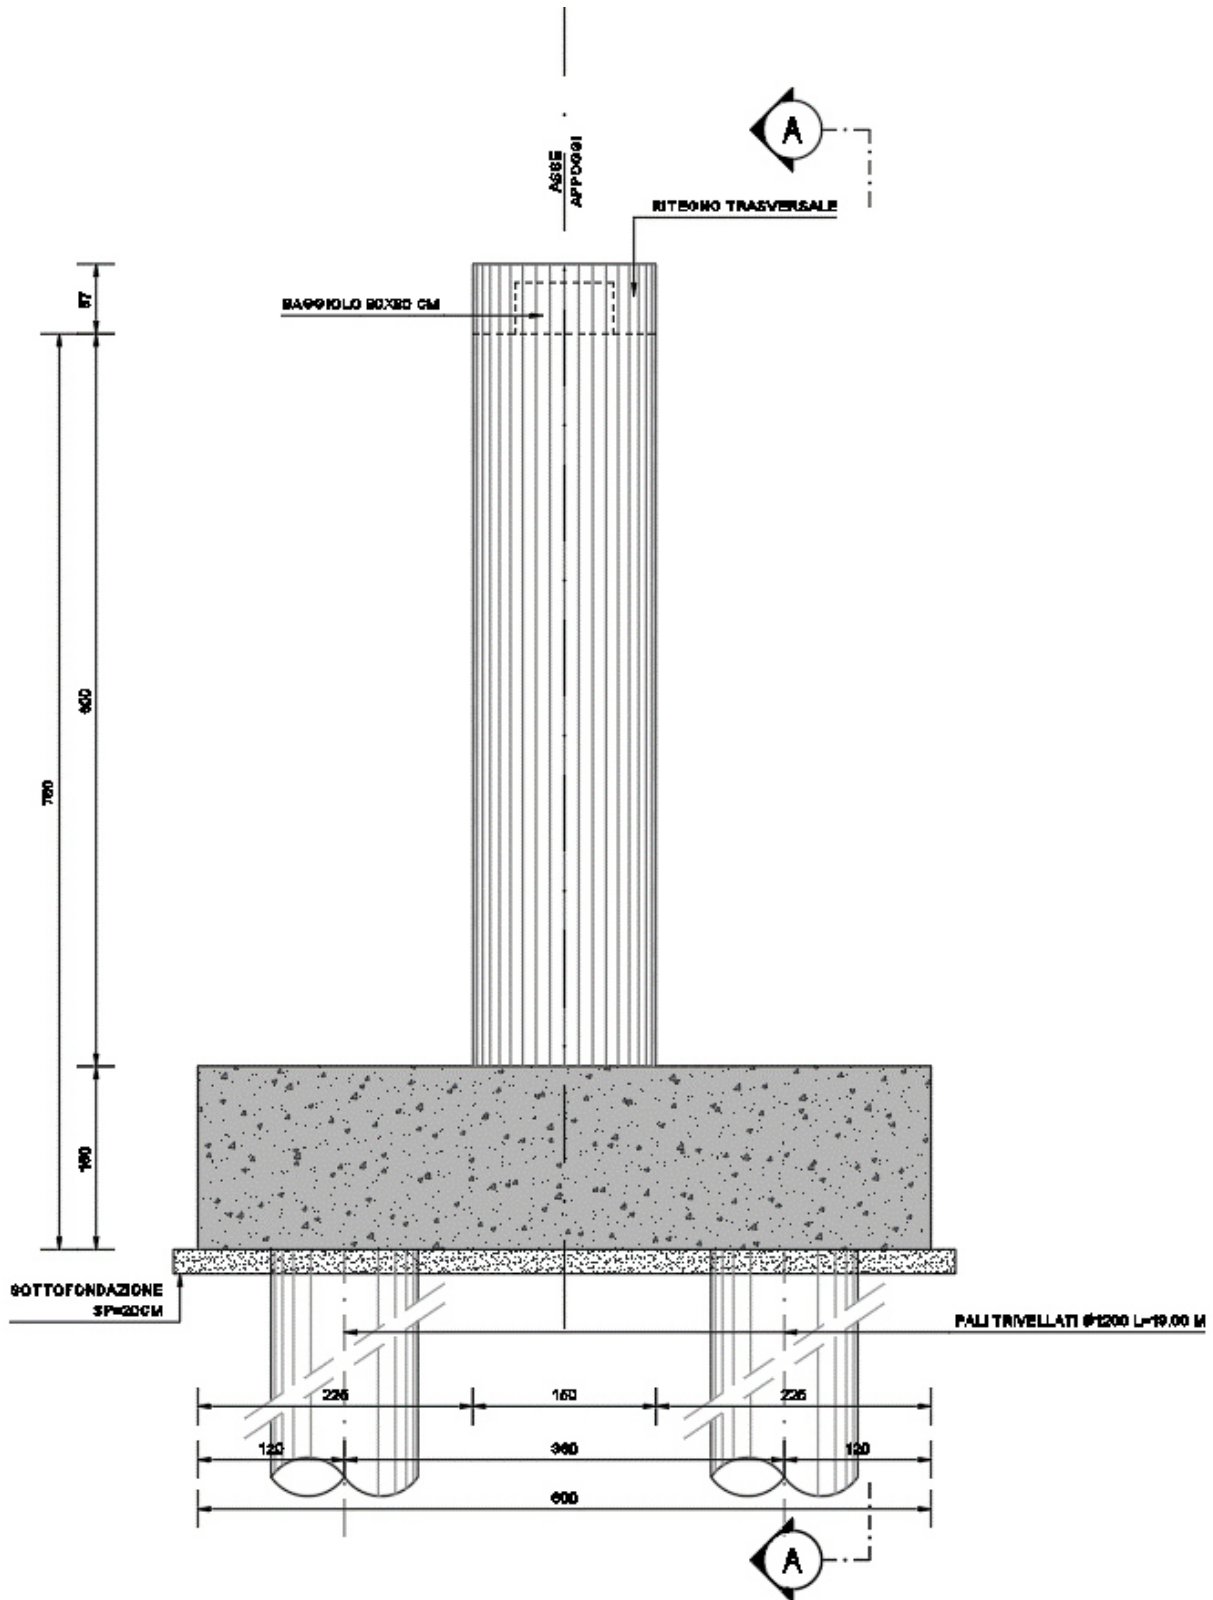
SEZIONE TRASVERSALE PILA
